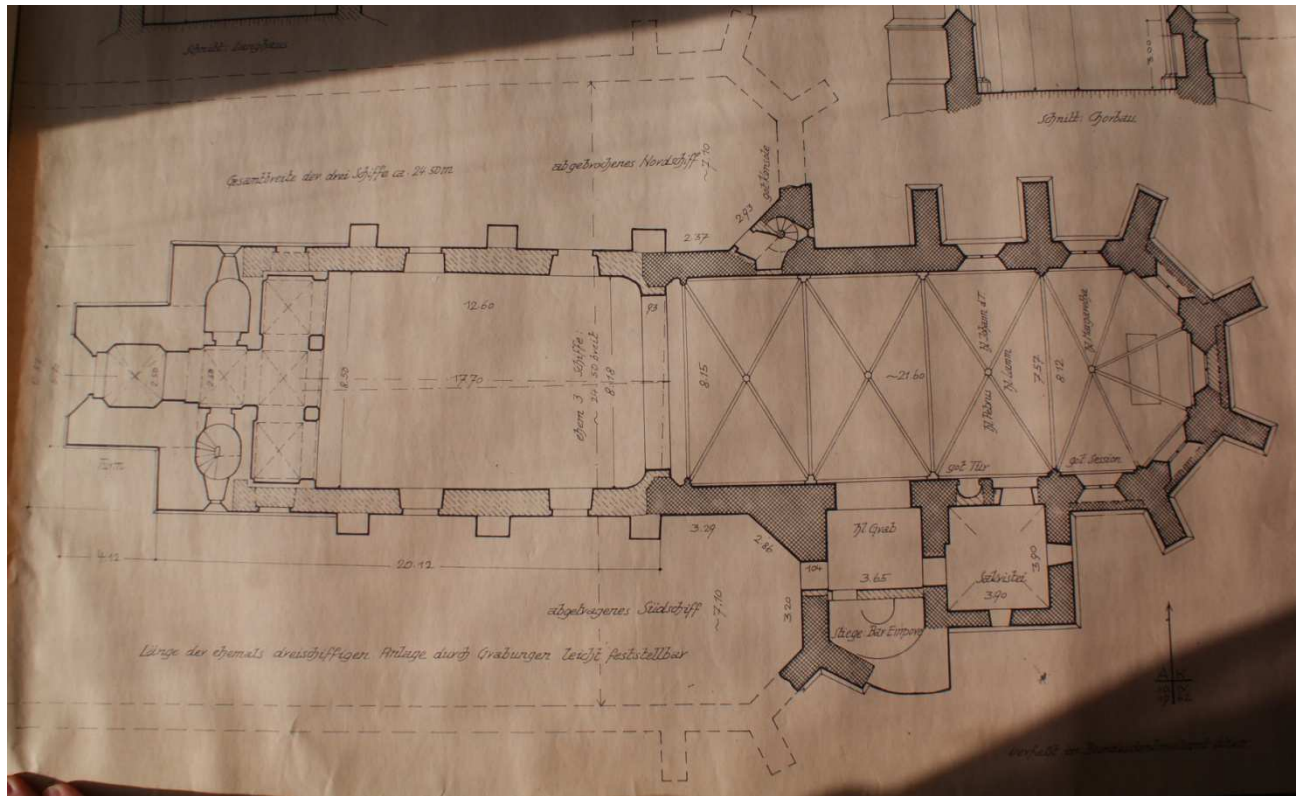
Grundrissplan der Kirche in Marchegg, nach Adalbert Klaar 1969
